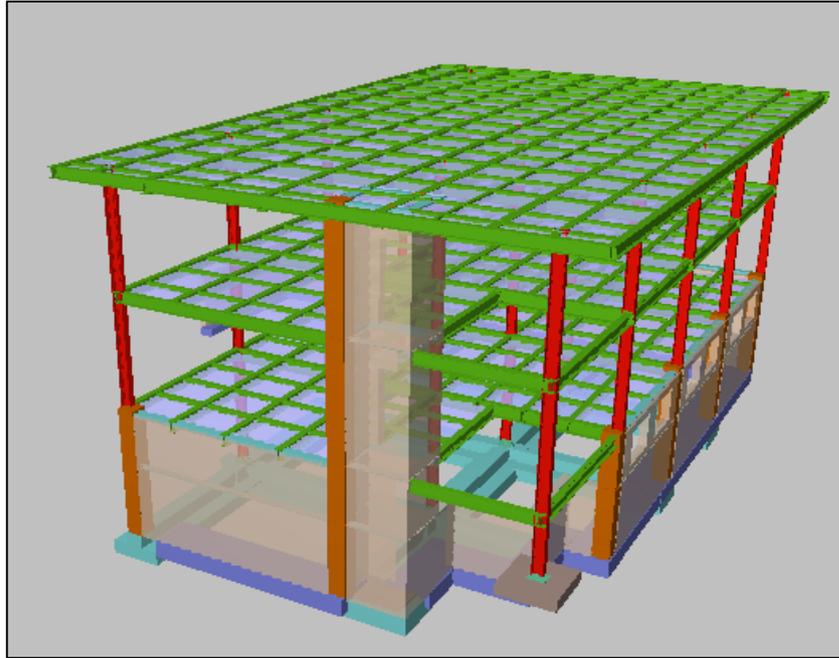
Modelo en Acero Estructural (lado izquierdo)
